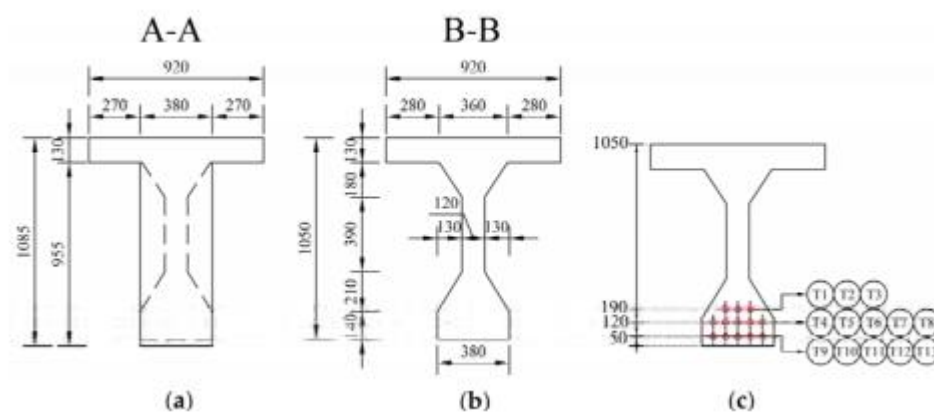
Plano de las secciones transversales del elemento (a) zona final, (b) zona central, (c) disposición de los tendones. (Fuente: Kralovanec, Moravčík, *et al.*, 2021)
